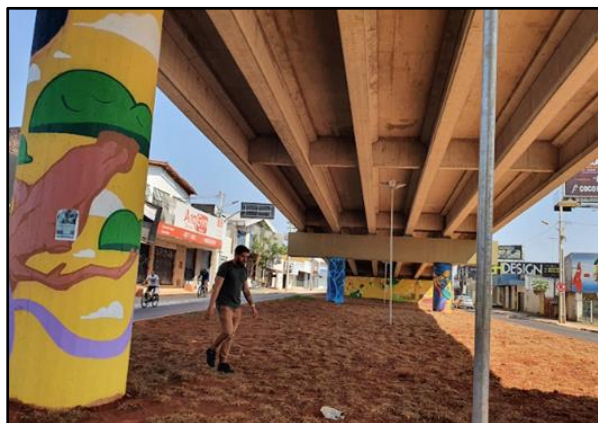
Movimento inseguro oriundo da Rua PL 1.
